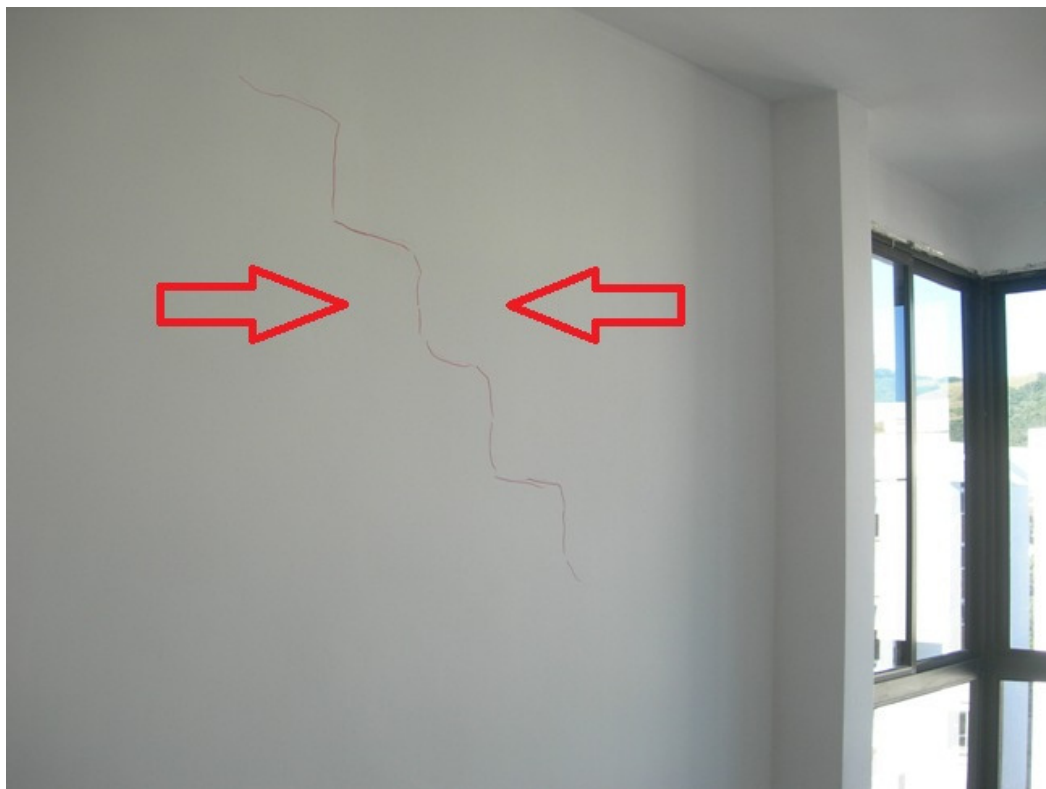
fissura interna ocorrida devido a aparelho deslizante mal executado
